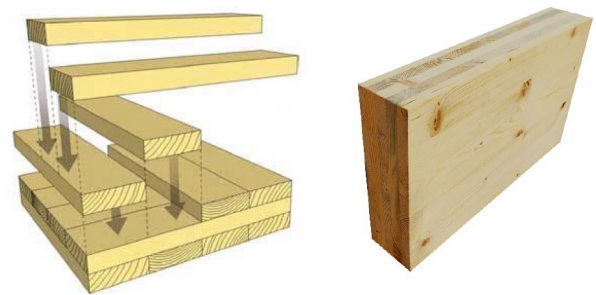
Configuration d'empilement pour les panneaux en bois lamellé-croisé (CLT) (source: Le Conseil canadien du bois, juin 2018).
